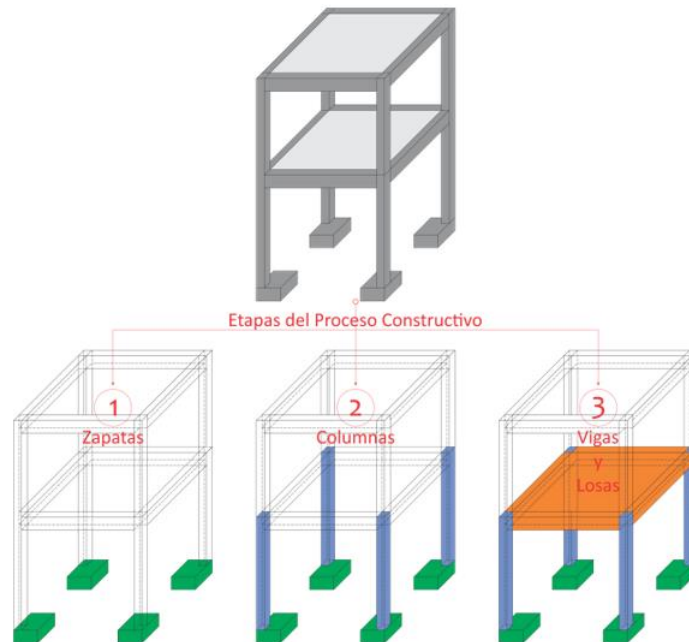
Proceso Constructivo del Sistema Estructural Aporricado.
